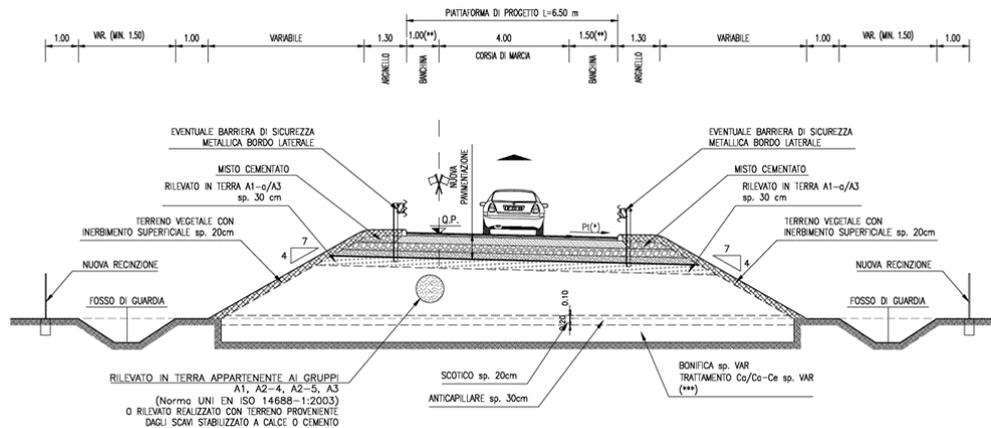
Sezione tipo rampa monodirezionale in rilevato
